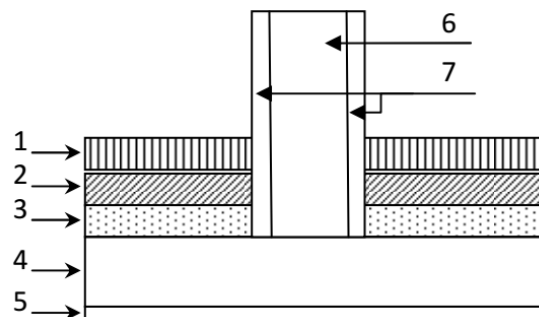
Coupe d'un plancher étage courant et RDC (en corps creux). [6]
